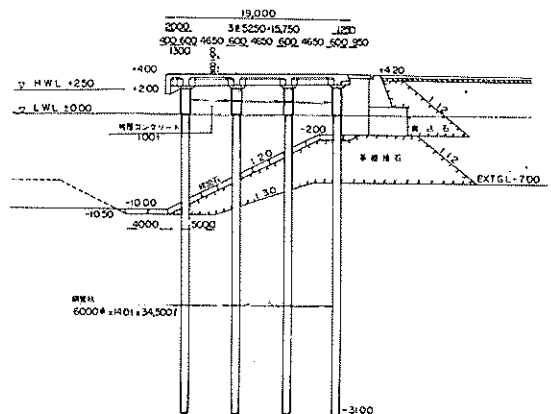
横棧橋式 - 10.0 m岸壁標準断面図
